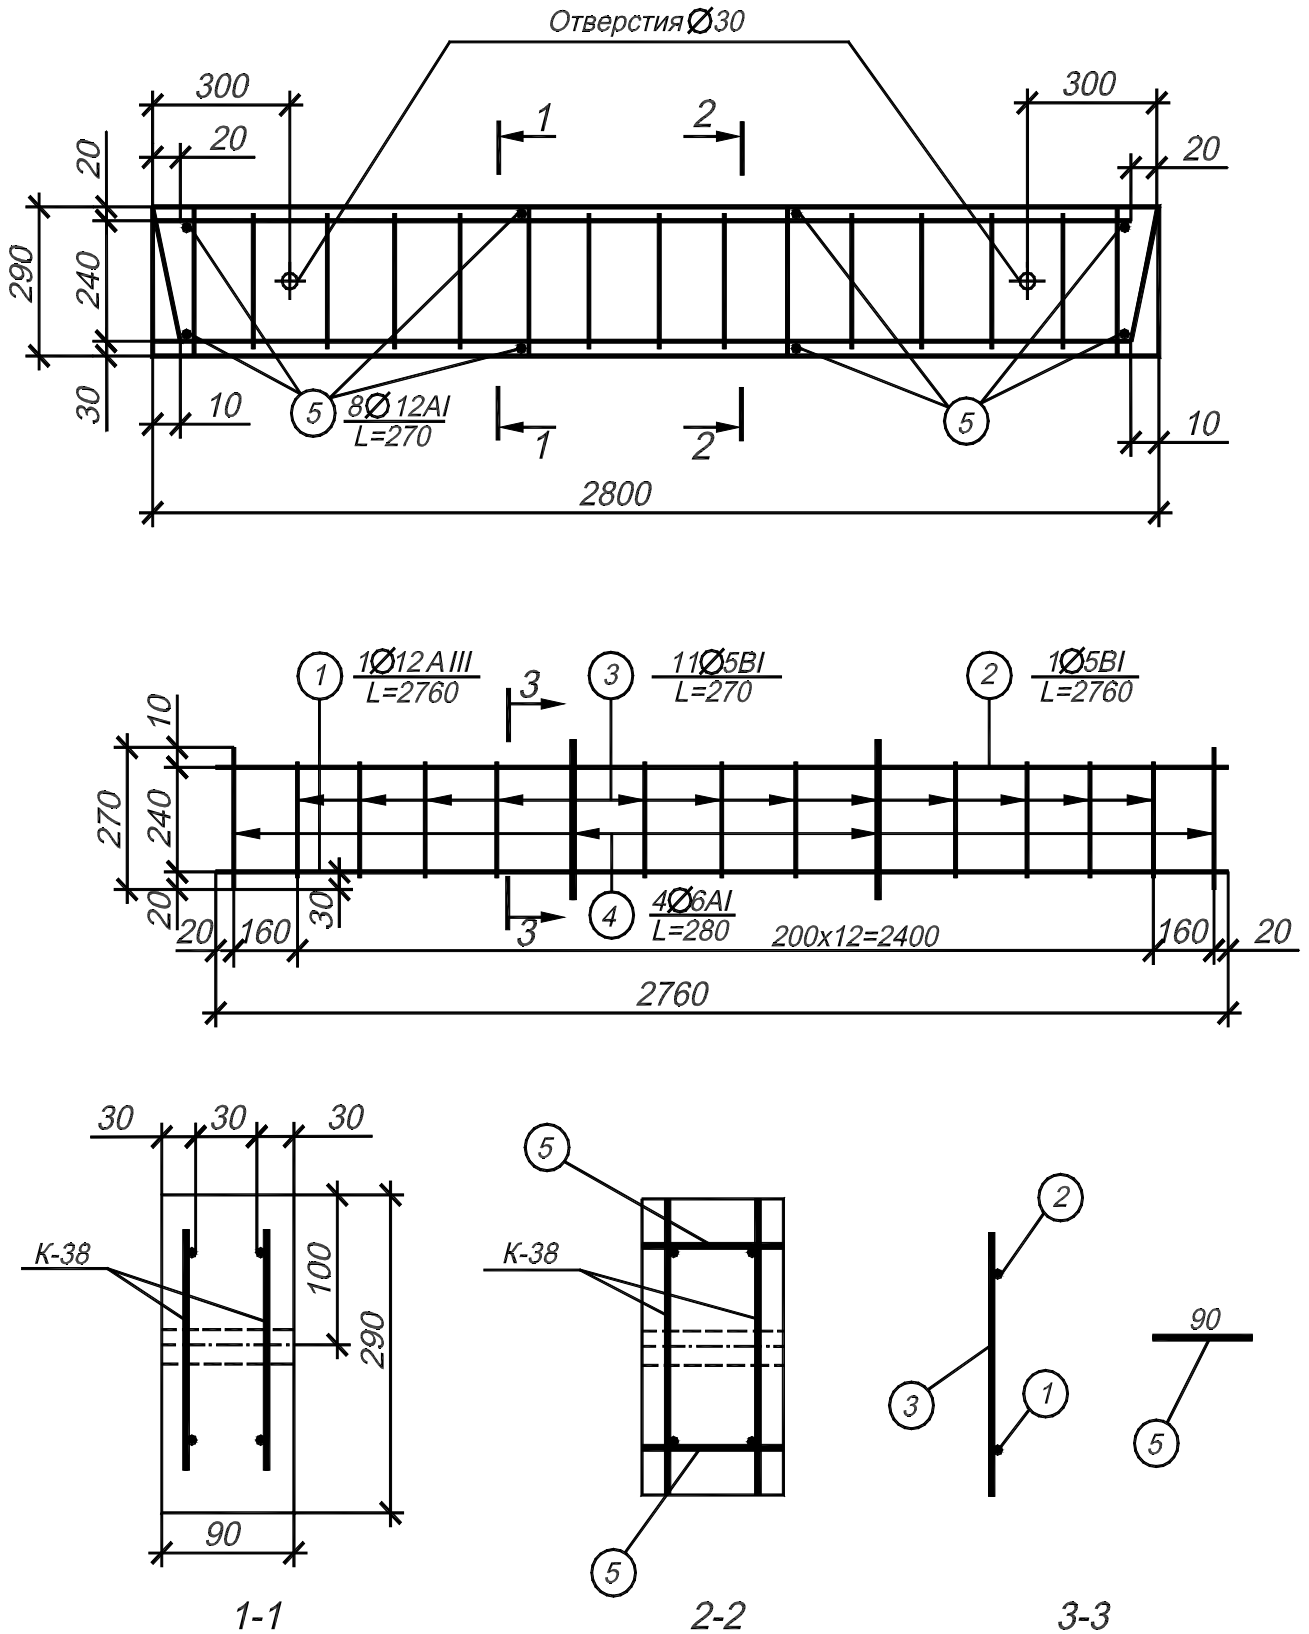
Варианты 1, 2, 3, 4, 5 задания «Железобетонные конструкции». Перемычка брусковая ШУ-26
